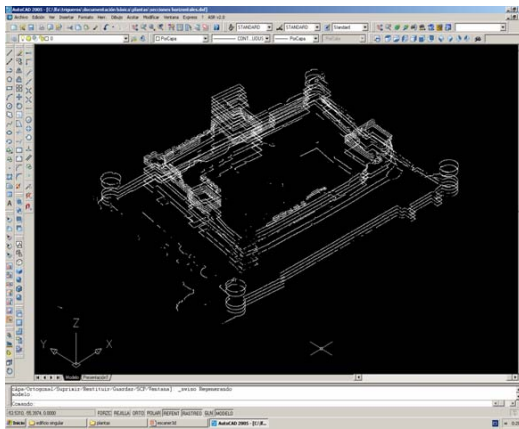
Secciones transversales paralelas a la Planta del Castillo de Trigueros del Valle
